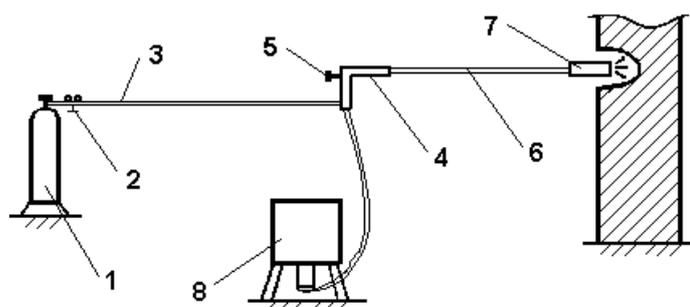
Схема термитно-кислородной установки для резки железобетона.
